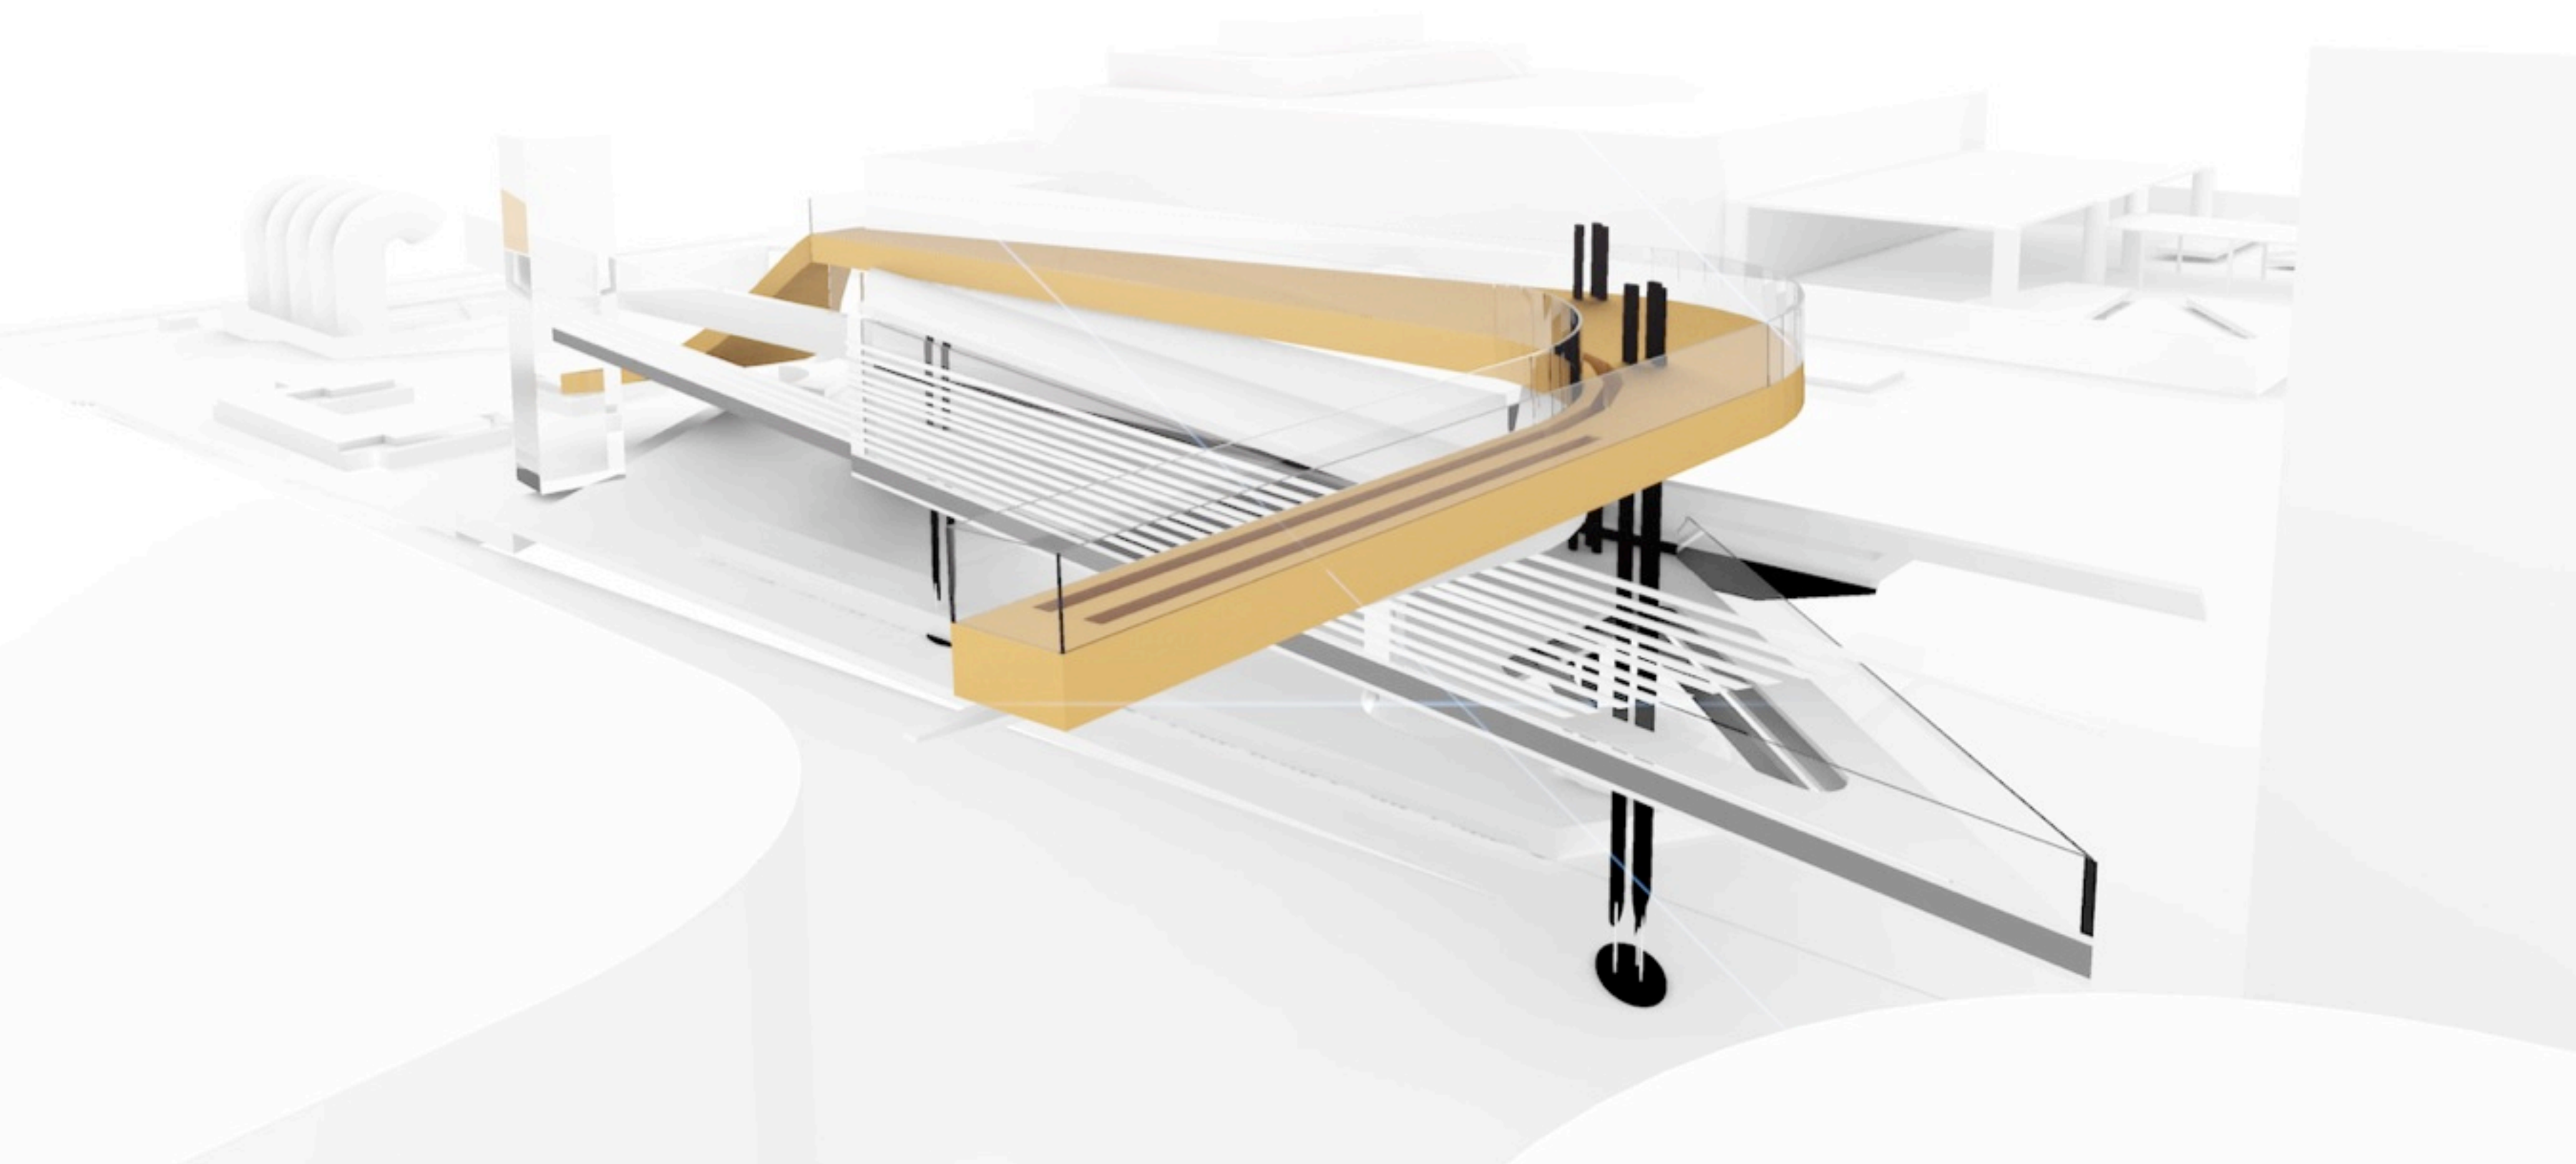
Vista desde acceso norte/ Fuente: Autor
